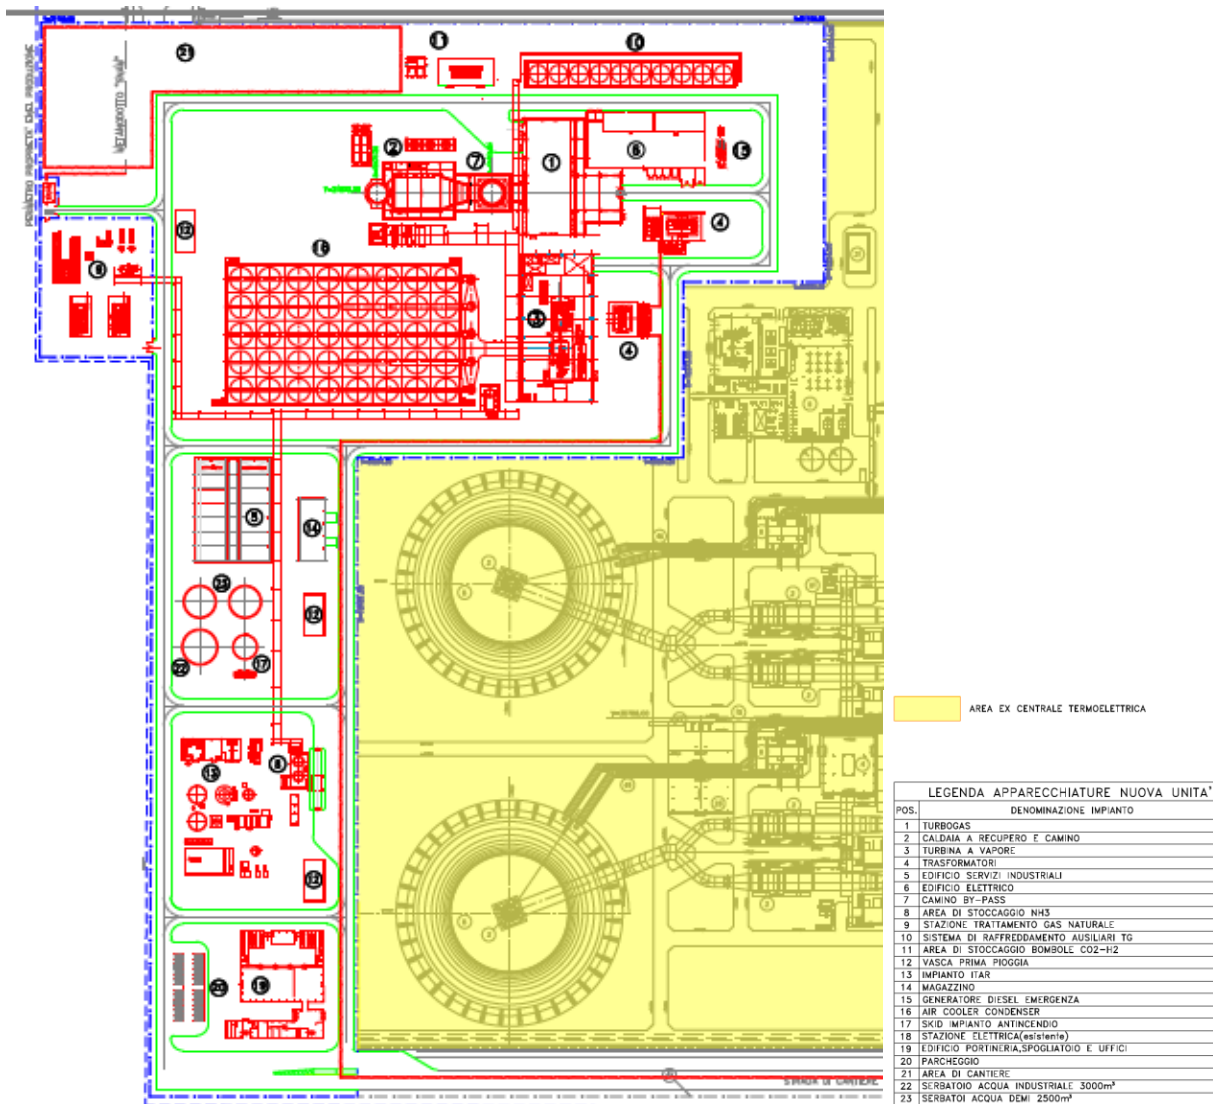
Stralcio della Planimetria della Fase 2 - CCGT
